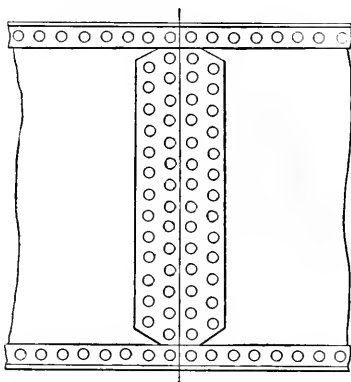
PLANCHAS DE UNIÓN DE LAS VIGUETAS PRINCIPALES
